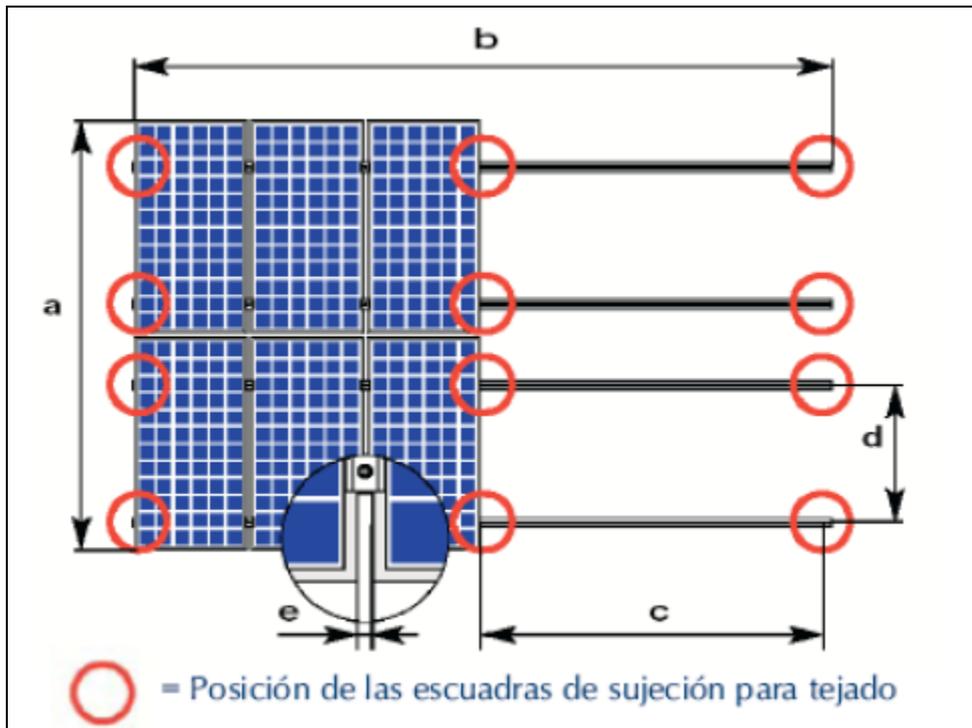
Esquema de disposición de los paneles solares sobre la cubierta
